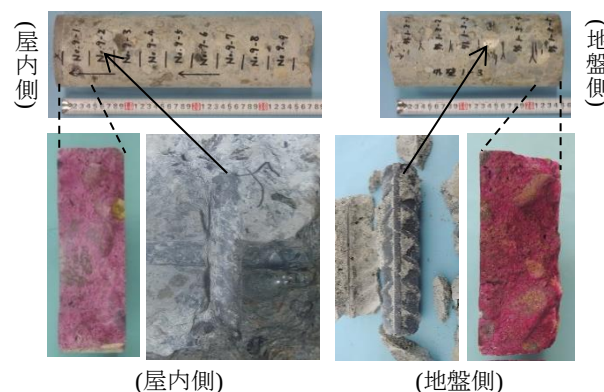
地下擁壁の中性化深さおよび鉄筋腐食状況
